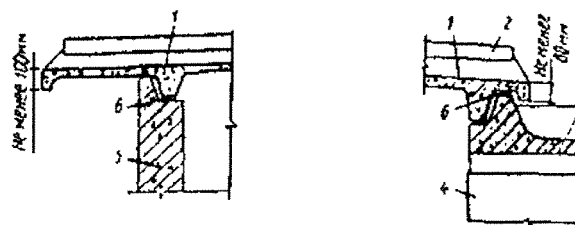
Сливные свесы кровельной панели для крыш с наружным неорганизованным водоотводом
